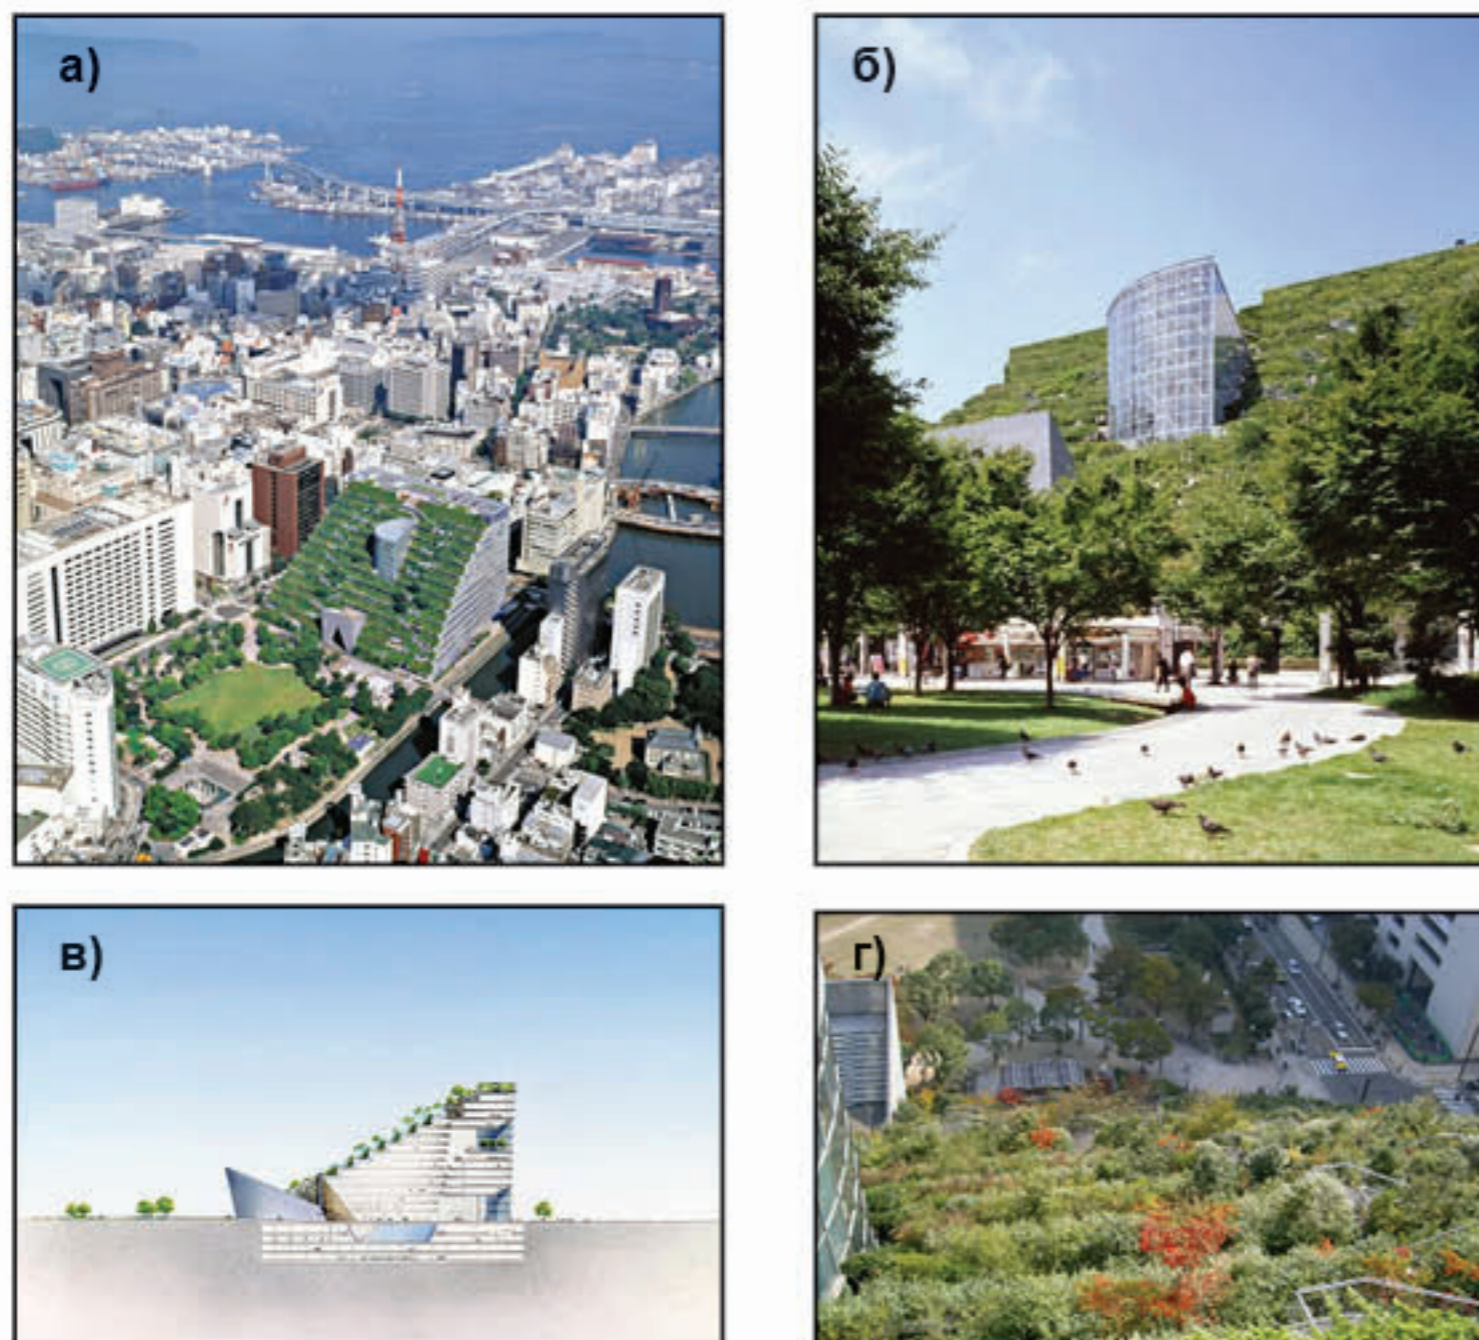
а) Вид сверху на ACROS и сквер, б) Вид на южный фасад из сквера, в) Разрез здания ACROS, г) Вид на сквер из сада на крыше.
